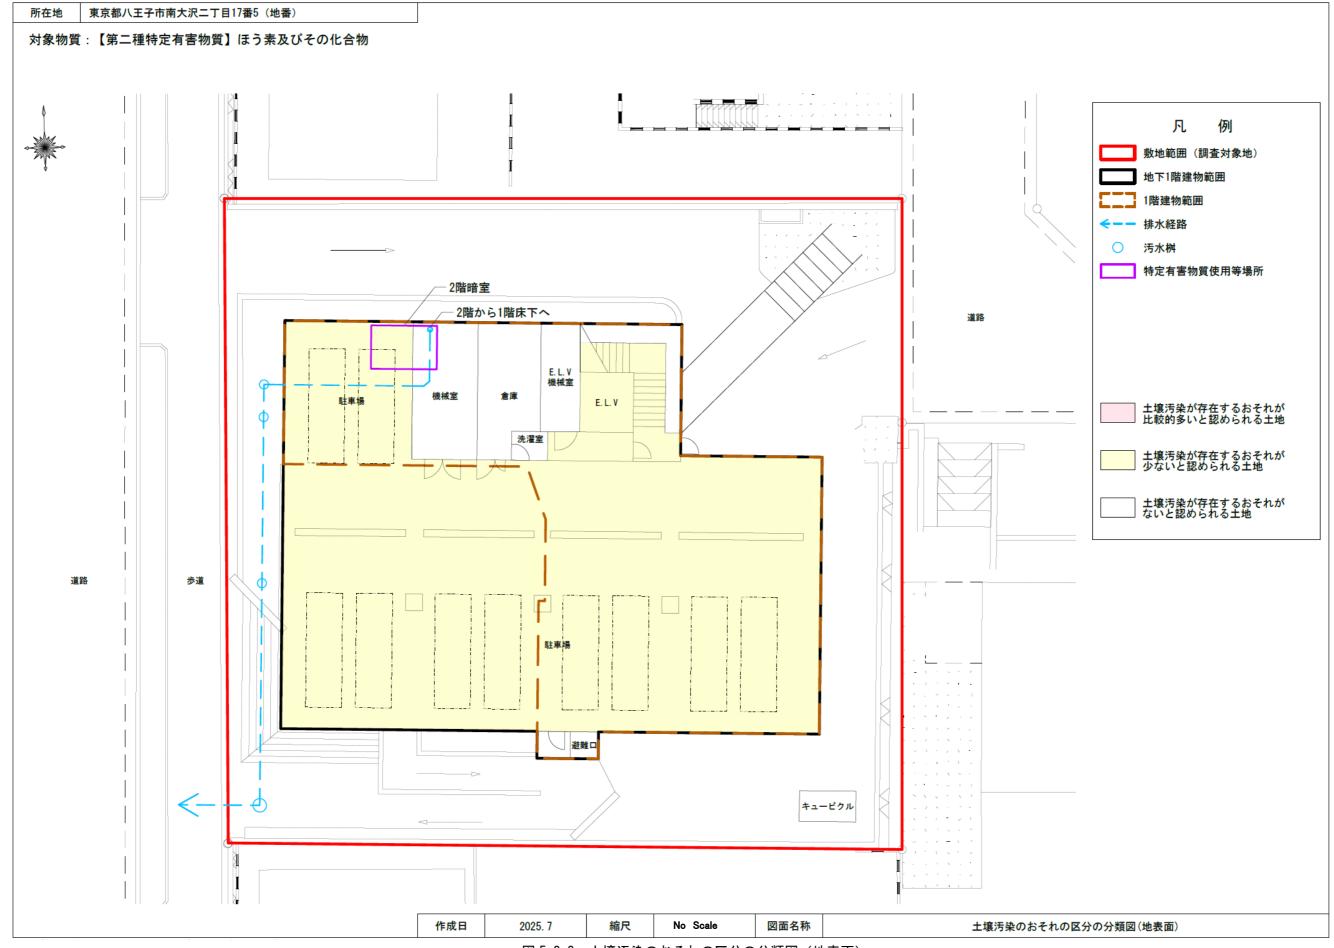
土壌汚染のおそれの区分の分類図(地表面)
